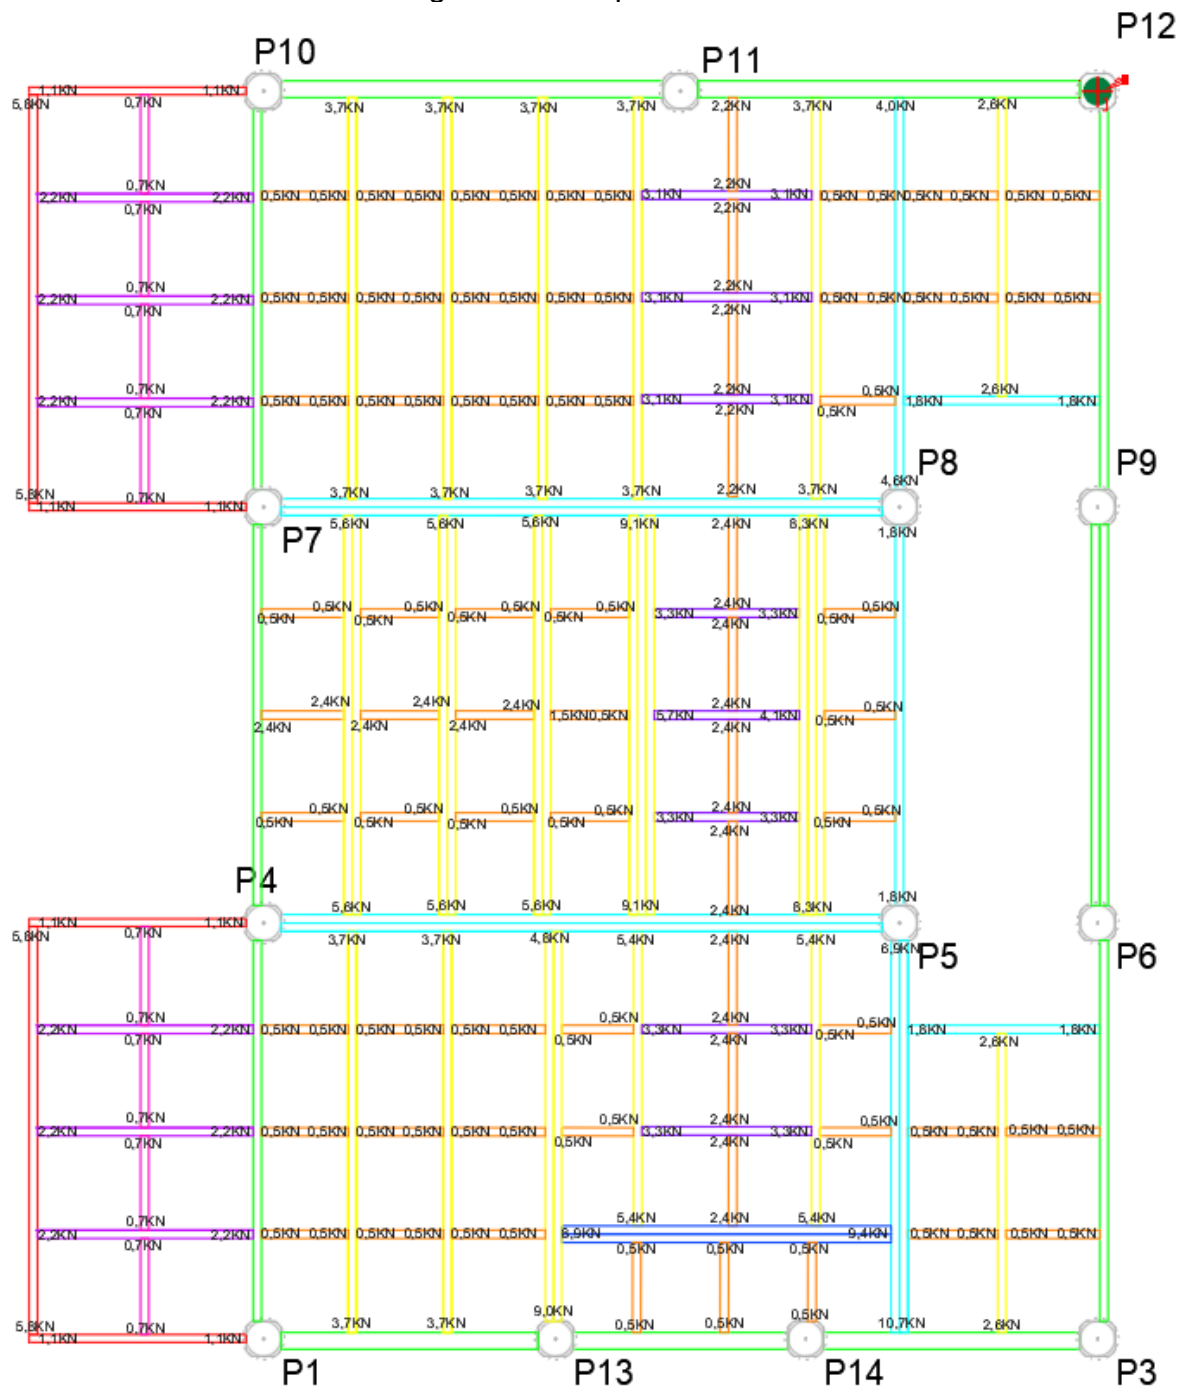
Técnica em que insere valores de força que se descarrega para outros elementos da cobertura para facilitar transferência de dados das vigas isoladas para as fachadas
